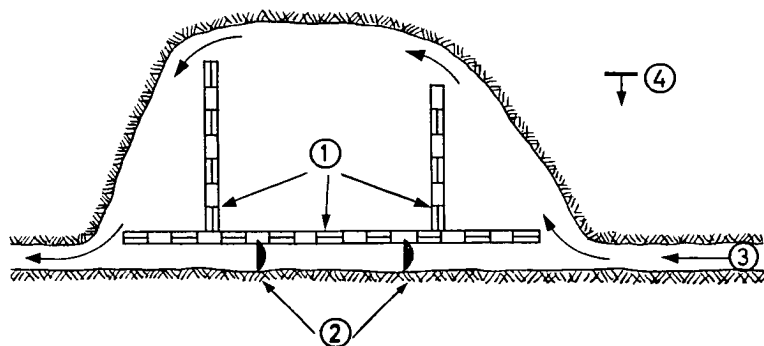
Murs d'aérage dirigeant l'air sur un chantier en dressant non relié au niveau supérieur.
